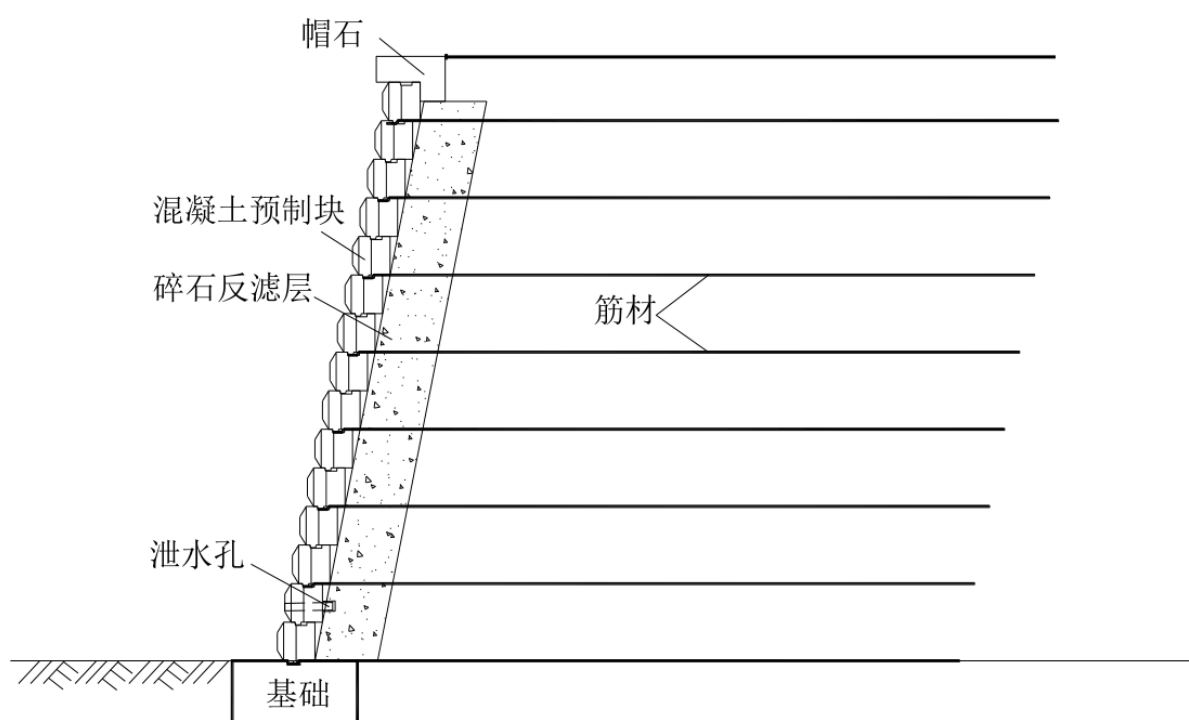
预制混凝土模块式墙面加筋土挡墙示意图
